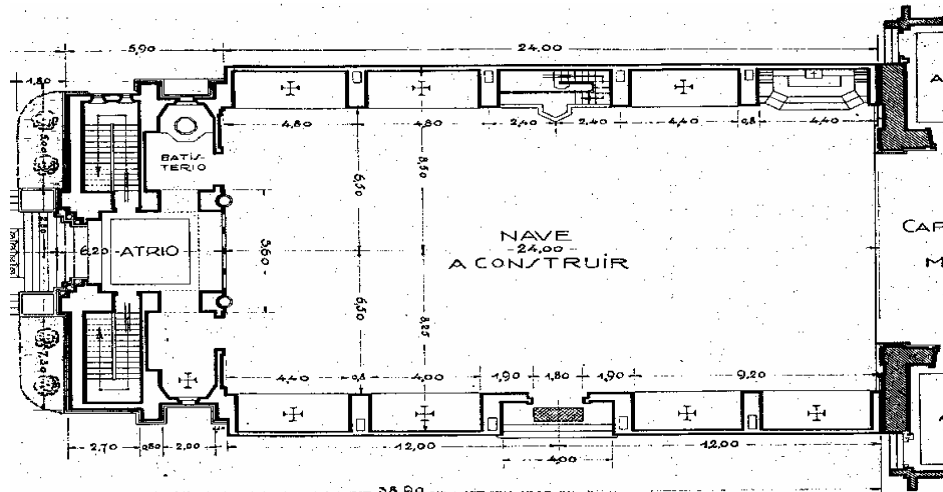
Planta da igreja do Santíssimo Sacramento (Porto) [3]
